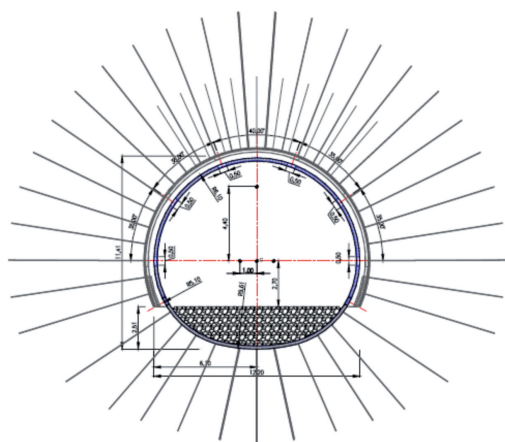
Sezione trasversale del tunnel (DSM) con il sistema di sostegno adottato per il profilo di scavo. *Tunnel cross section (DSM) showing the excavation/support system adopted.
